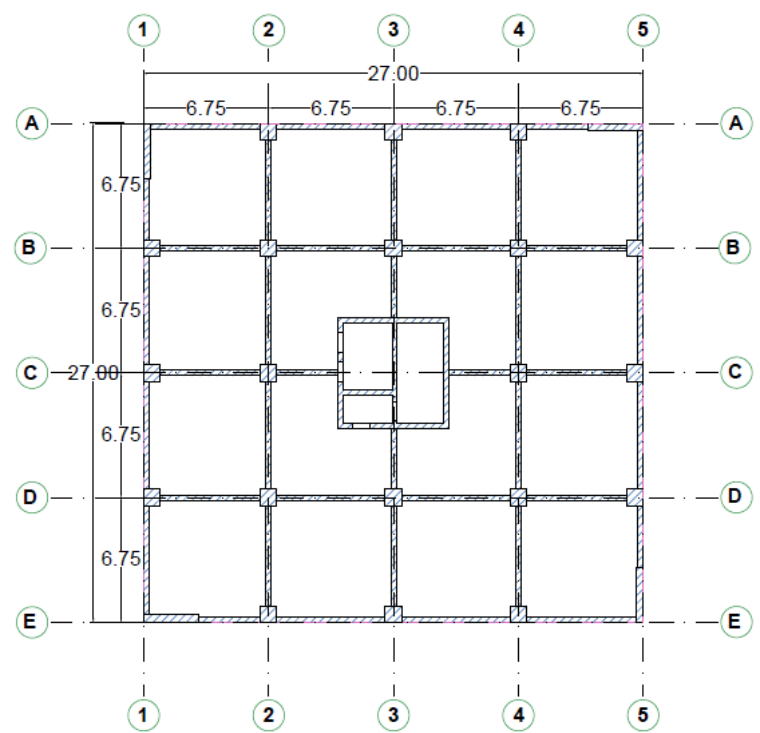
Planta do piso 1 - Variante Estrutural B
